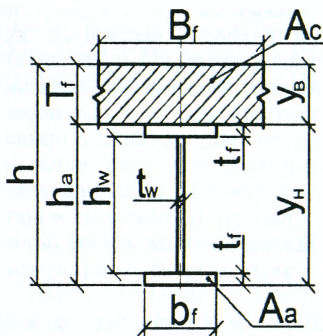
Общее приведенное сечение СЖБ элемента с бетонной верхней полкой
